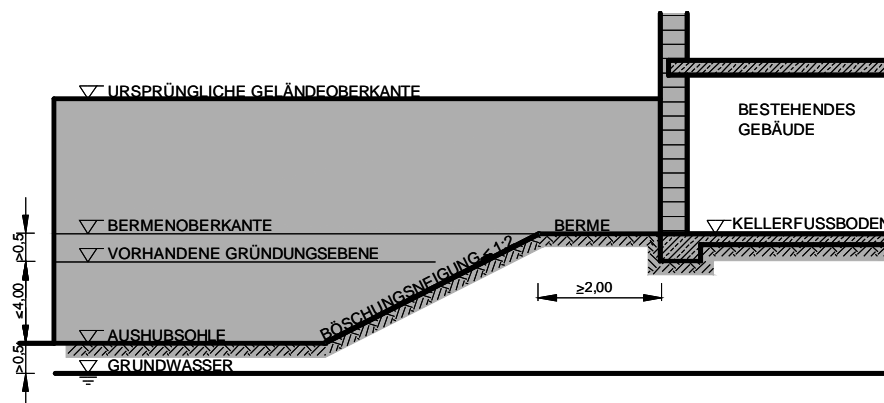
Aushubgrenzen bei Ausschachtung neben bestehenden Bauwerken
